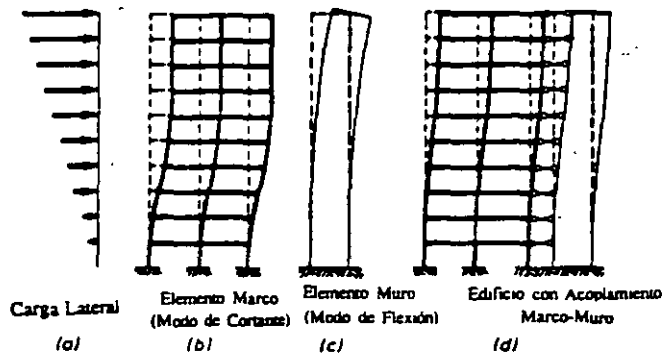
Patrones de deformación ante cargas laterales de un marco, un muro y un sistema mixto muro-marco
